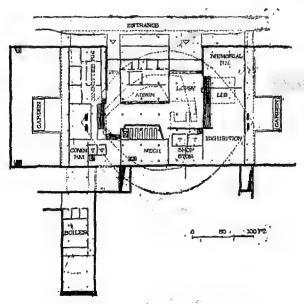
٢٧ - ٣ : المسقط الأفقى لصالة المؤتمرات الدولية وتتسع لعدد ١٢٠٠
